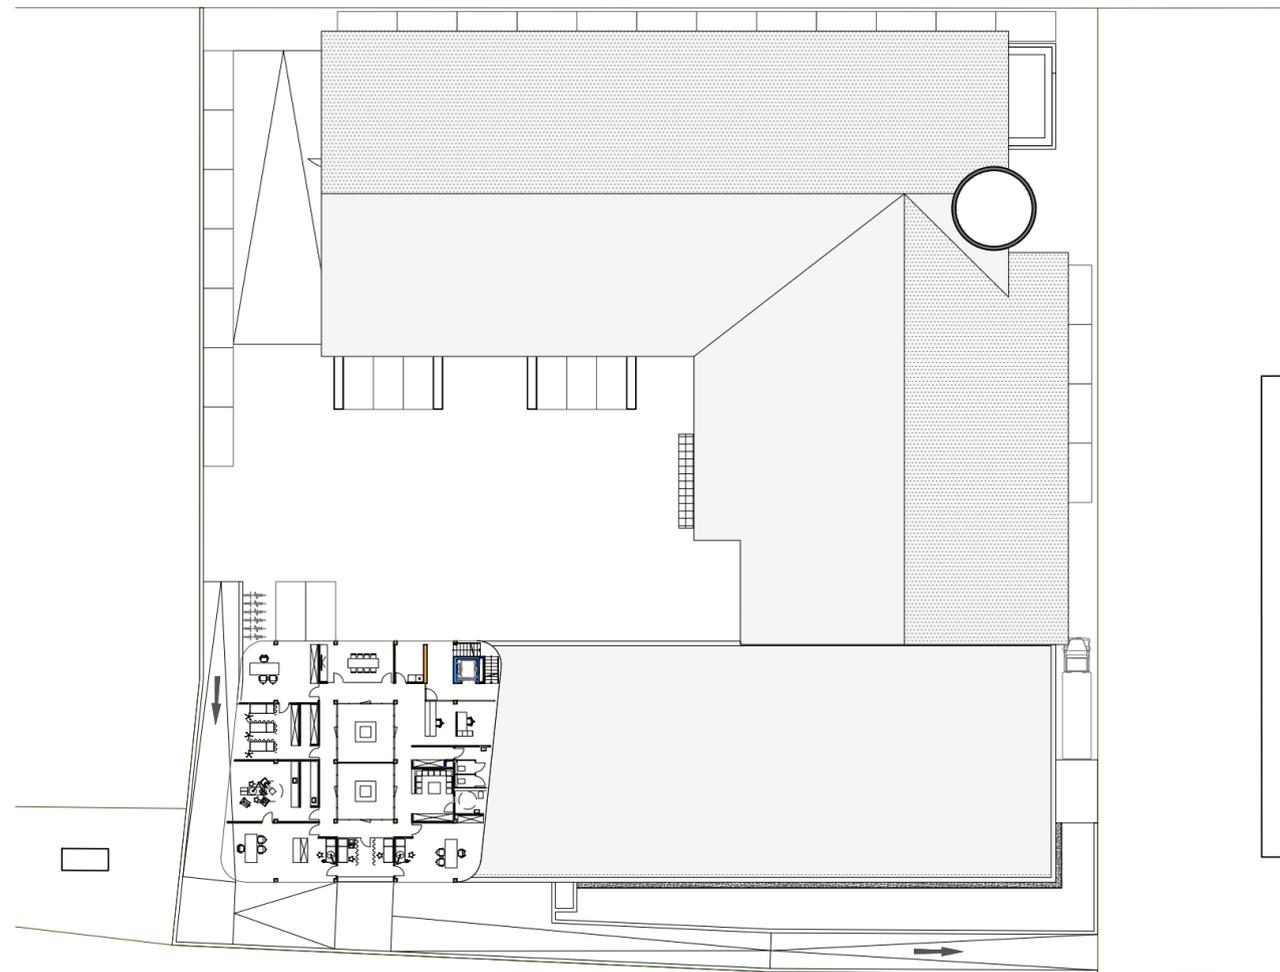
Vorentwurf III - Grundriss 2. Obergeschoß
